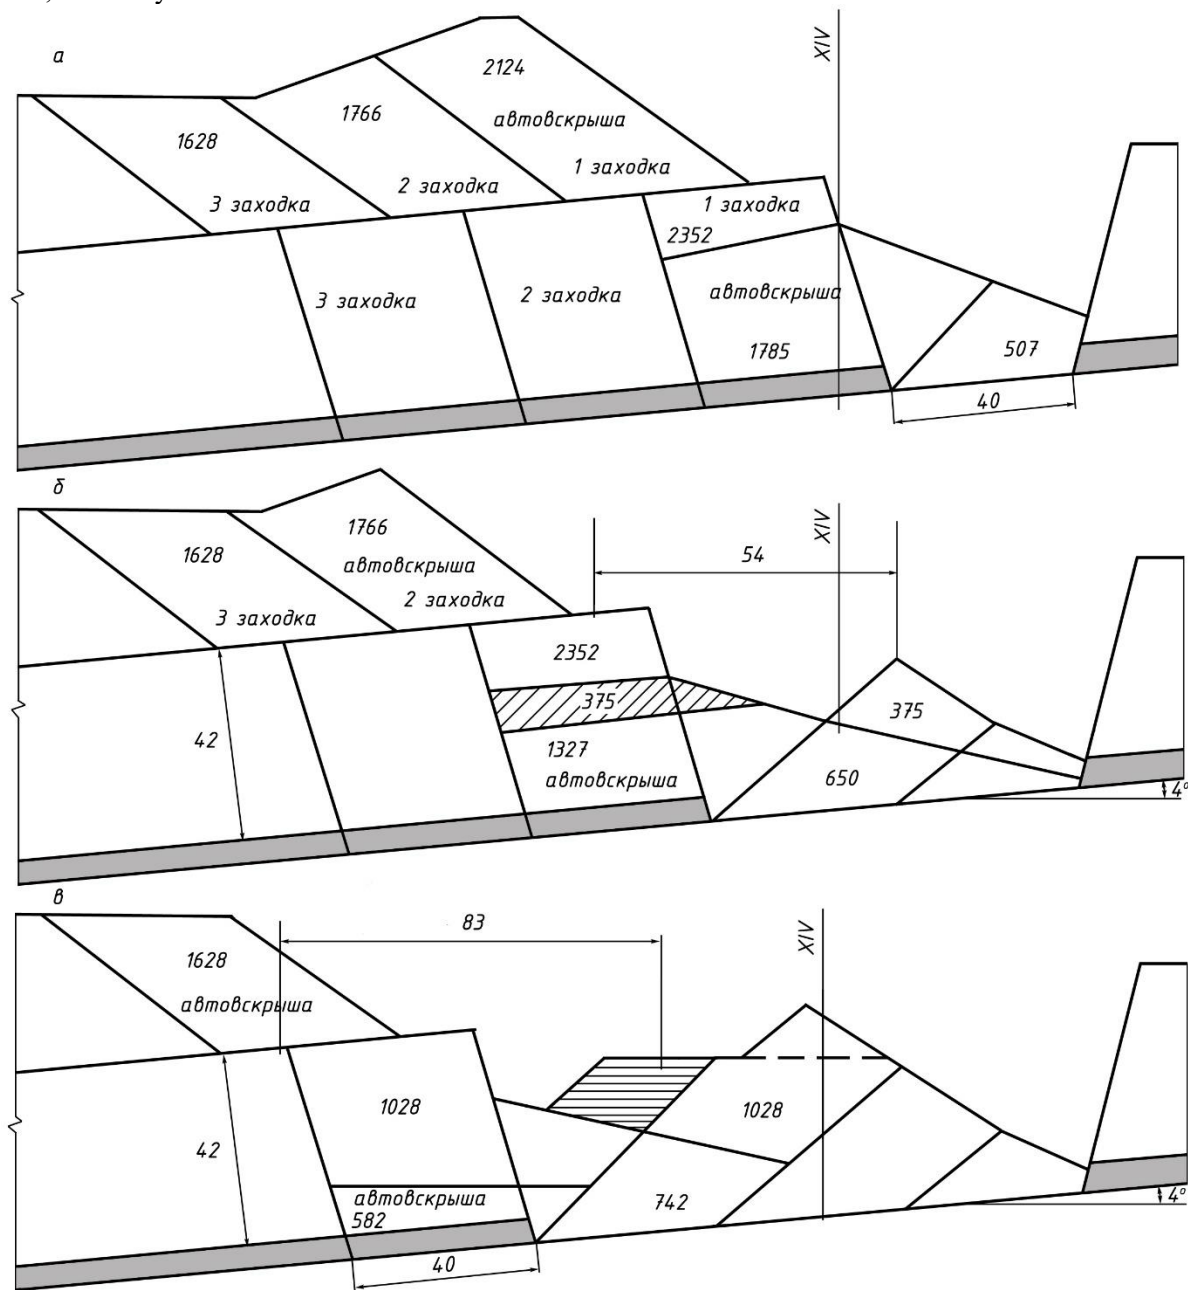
Схемы экскавации драглайна ЭШ 20.90 для создания опорного навала: а, б, в – разработка первой, второй и третьей заходки соответственно от траншеи по падению пласта
